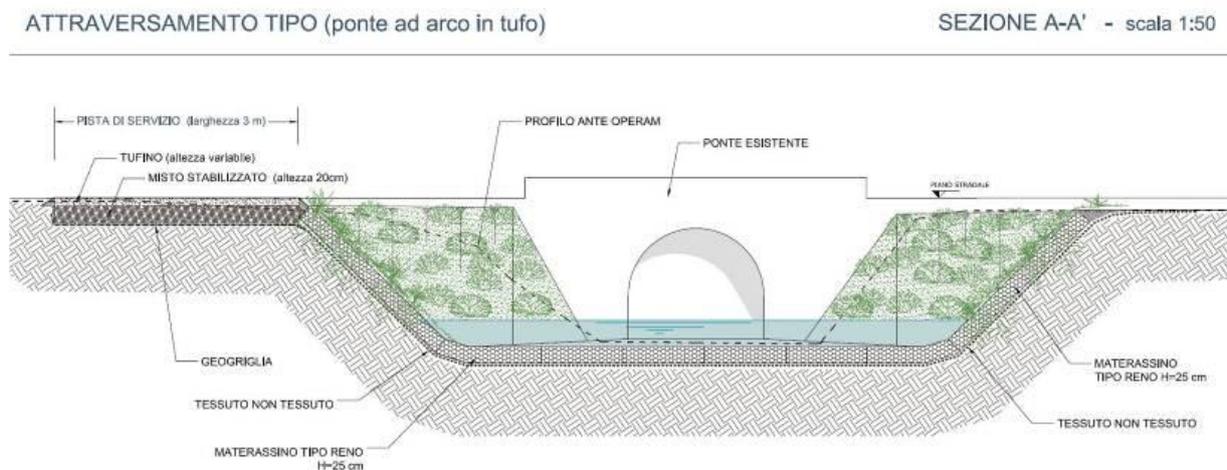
Sistemazione attraversamento tipo ponte in tufo esistente con materassi tipo Reno – vista lato valle.
